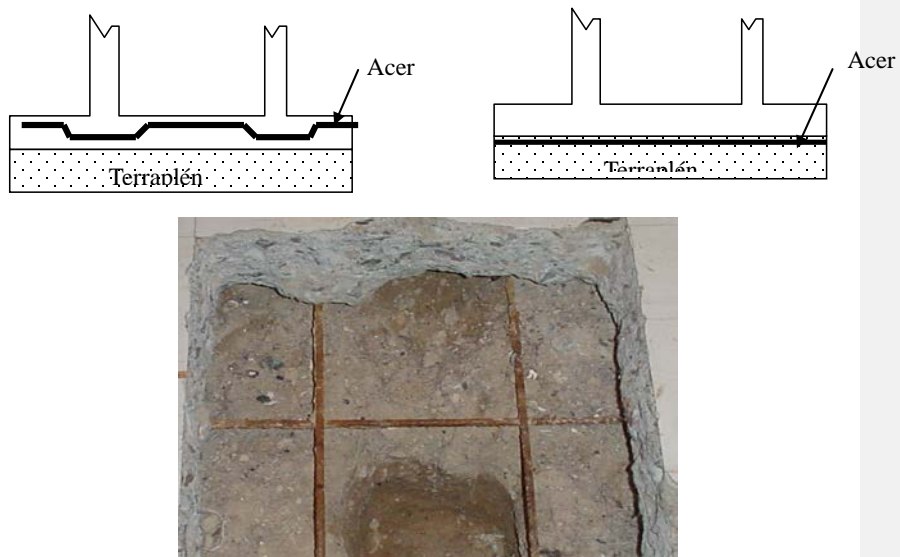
Acero de refuerzo fuera del concreto. Fraccionamiento ubicado en villas de Santiago de la Ciudad de Querétaro.
